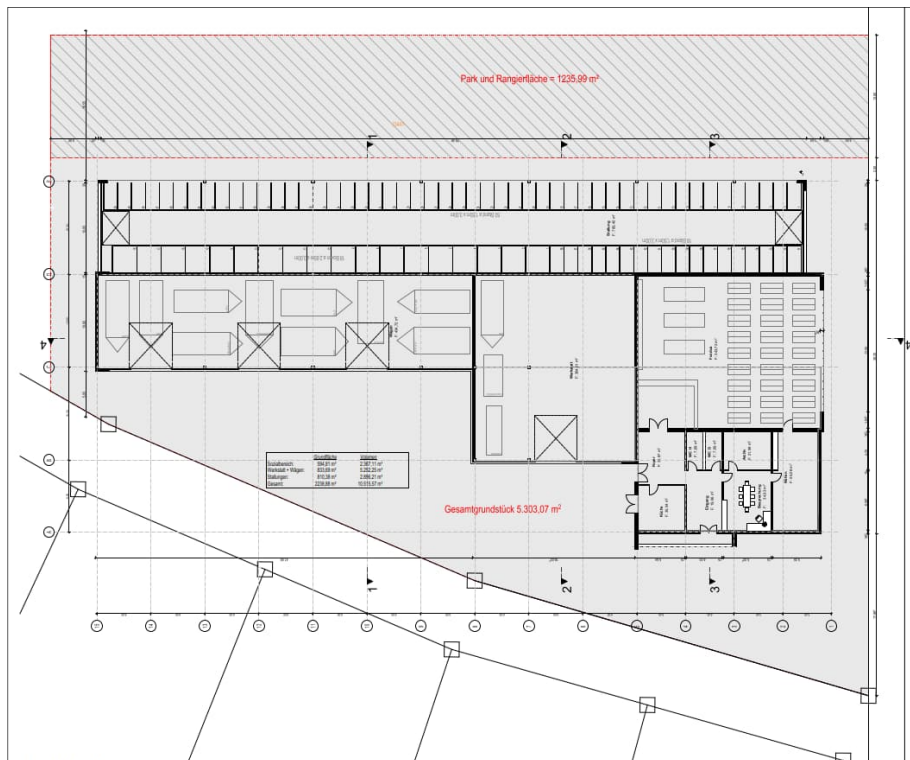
Lageplan mit Darstellung Grundriss Funktionsgebäude sowie Park-/Rangierfläche gemäß [b] [Verfasser: Architektur Beck, Schwabmünchen]
